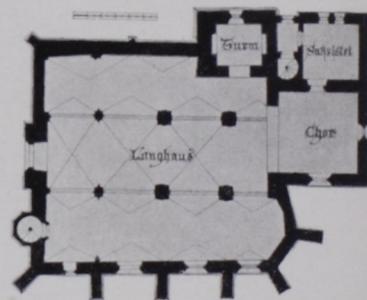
Sievering, Pfarrkirche, Grundriß 1:500 (S. 466)
